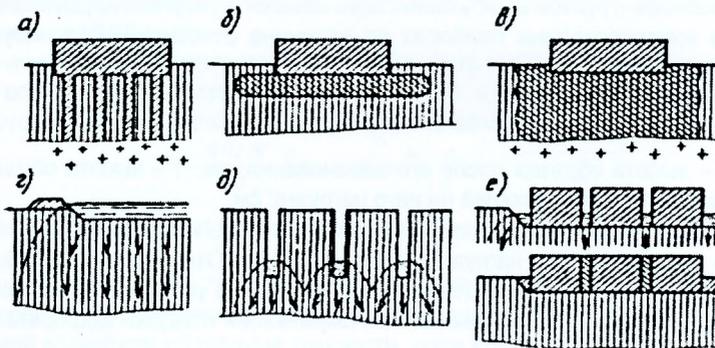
Схемы мероприятий по борьбе с просадками лессовых грунтов:
